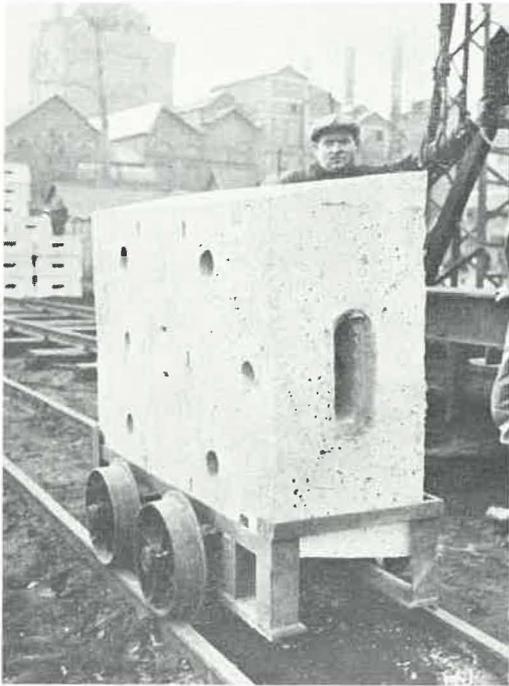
Claveau de béton placé sur un truck pour sa descente dans l'avaleresse.
